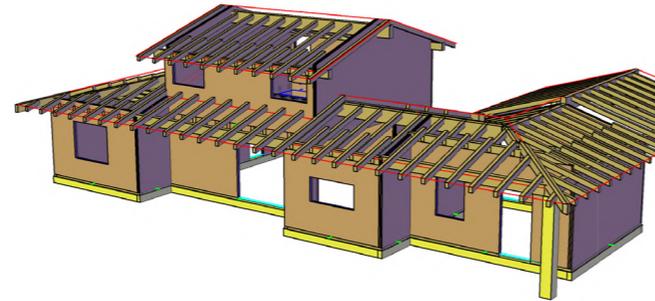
Modello strutturale tridimensionale realizzato dall'impresa costruttrice
